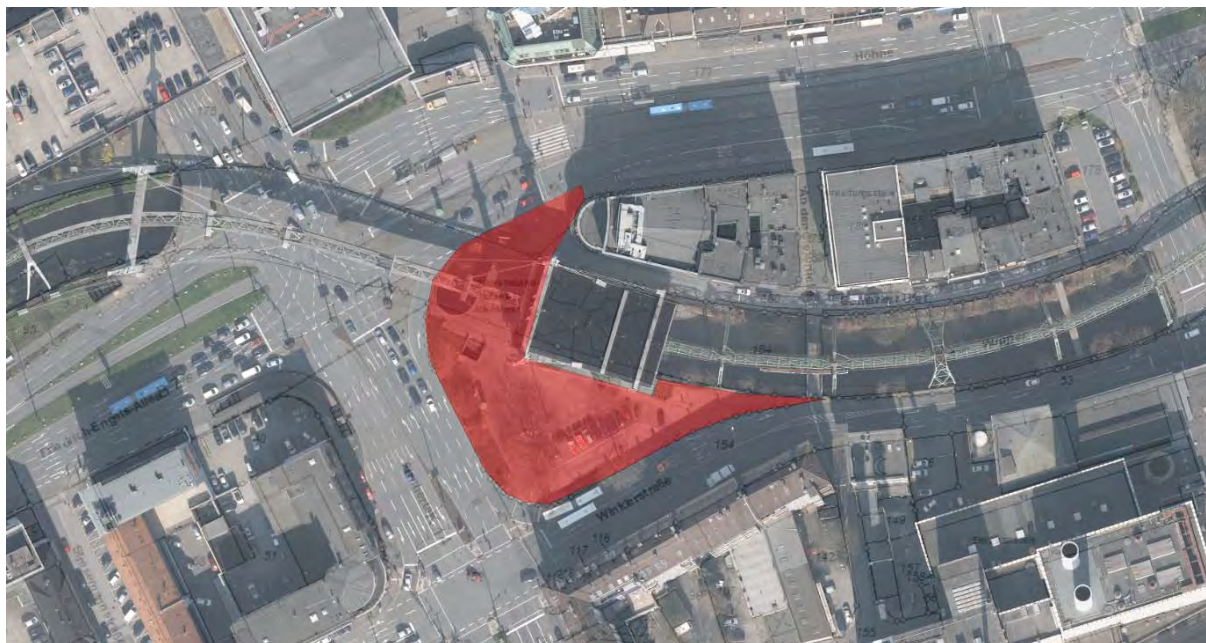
Lageplan Maßnahme Ankunftsort Schwebebahnhaltestelle Alter Markt
